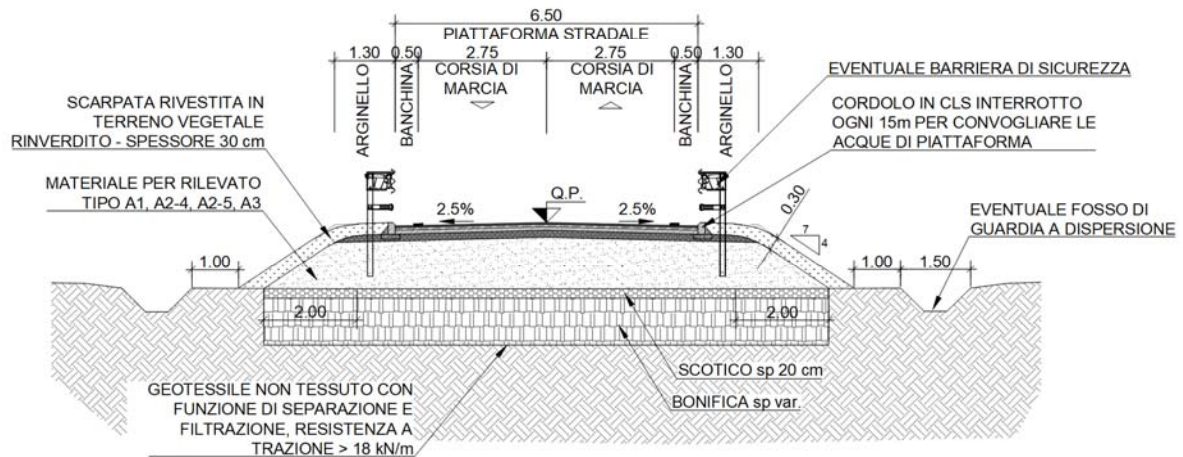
sezione tipo cat. Locale a destinazione particolare – L=6.50m
